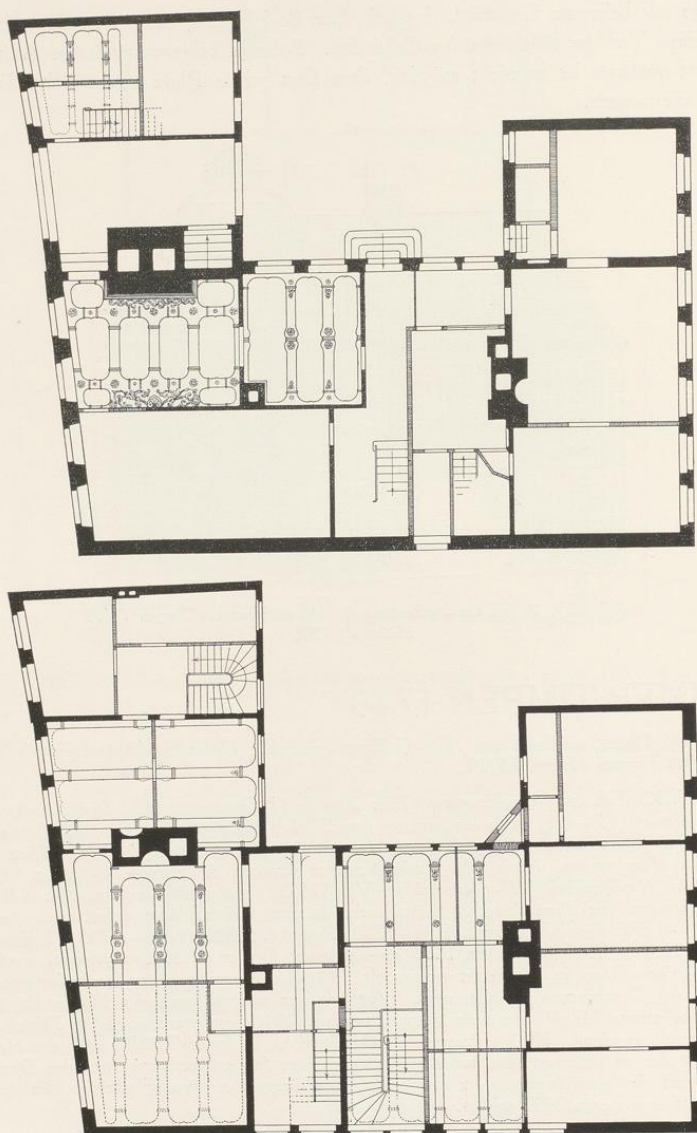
und 961. Grundrisse des Erdgeschosses (oben) und Obergeschosses
